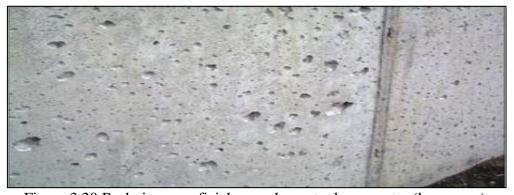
Burbujas superficiales en elemento de concreto. (lmcc.com).
